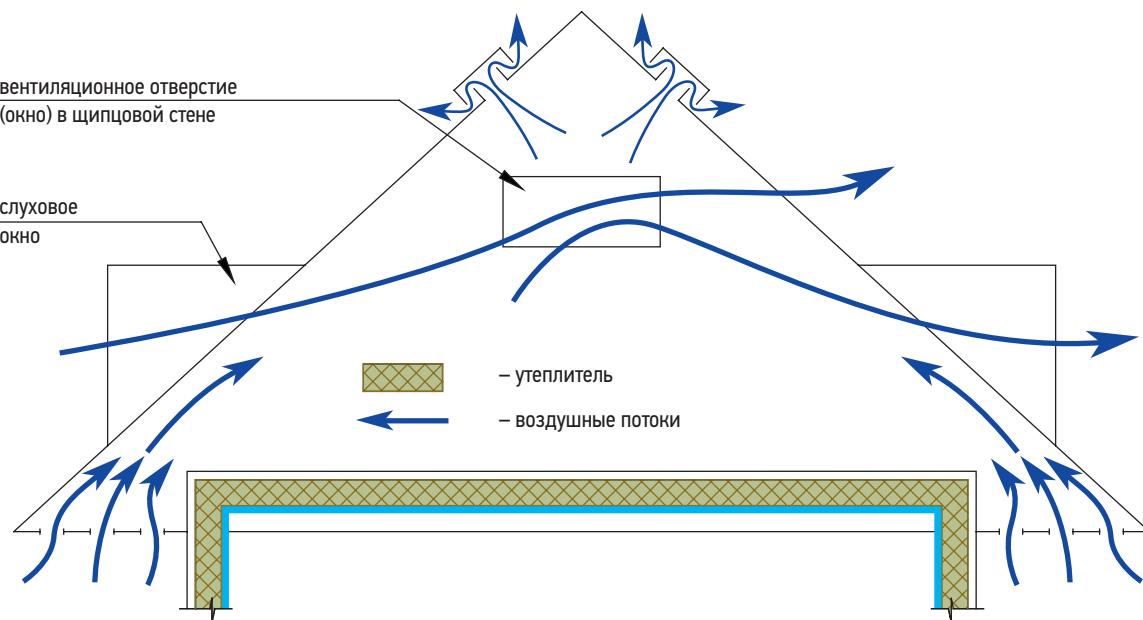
Схема утепления и вентиляции нежилого чердачного помещения
